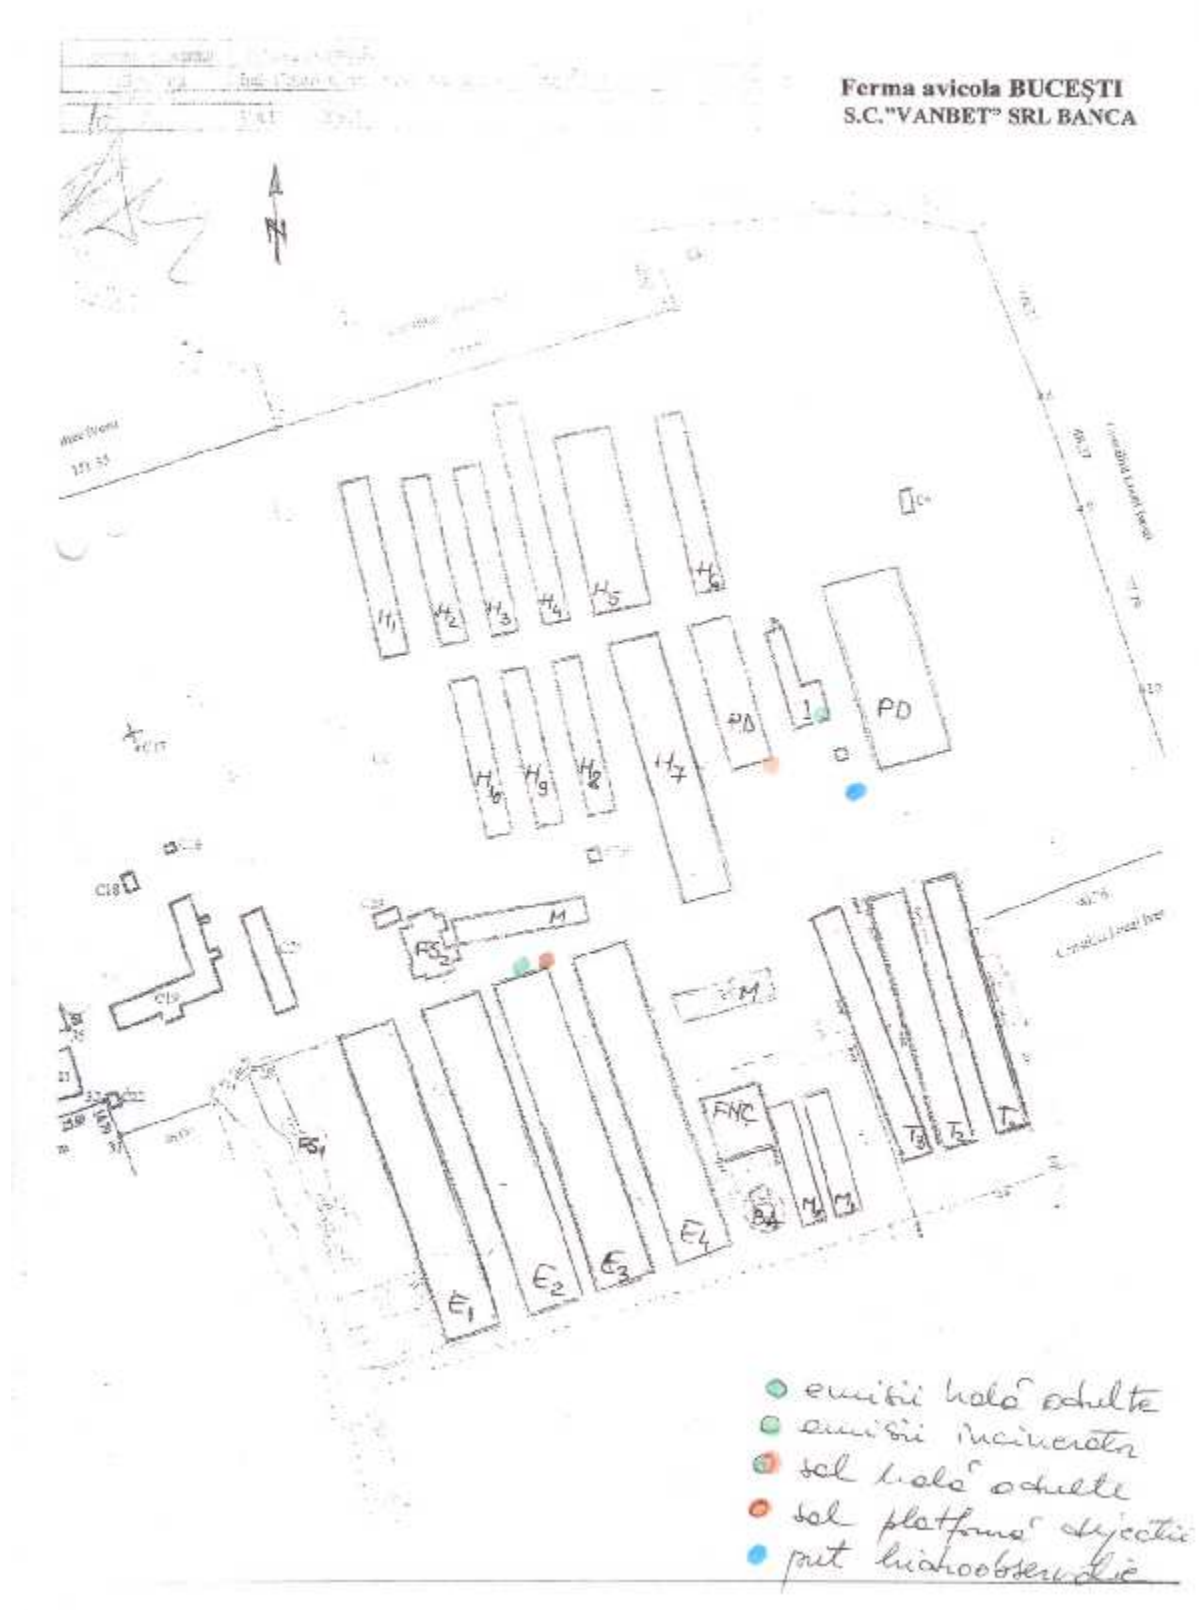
Plan încadrare zona - S.C. VANBET SRL
